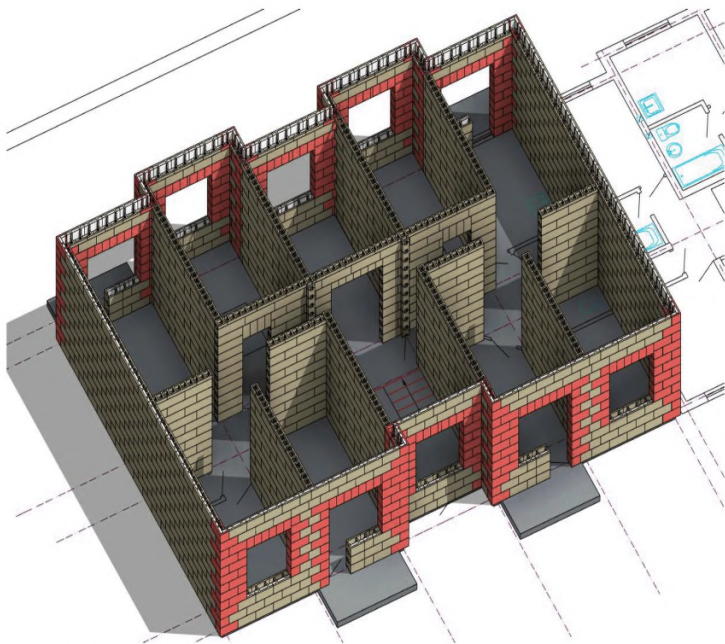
Объемно-планировочное решение этажа здания со стенами и перегородками из блоков
